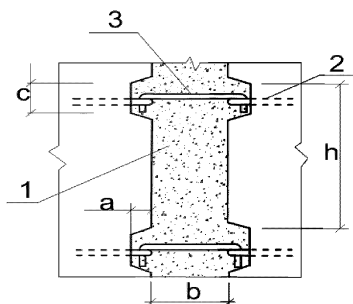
Шпоночные соединения с применением стальных выпусков и соединительных скоб: 1 – бетон замоноличивания; 2 – петлевые арматурные выпуски; 3 – соединительные стальные скобы. Глубина шпонки a – 60–70 мм; ширина устья стыка b – 100–120 мм; шаг шпонок h по расчетам
